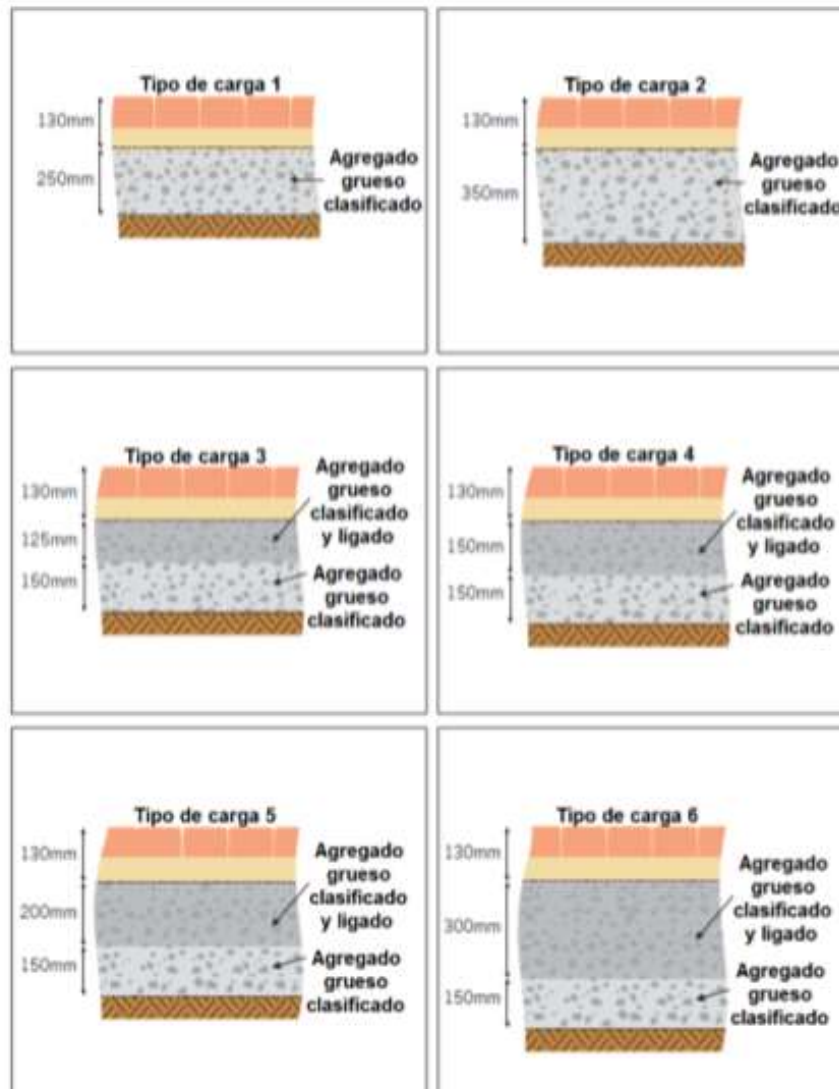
Espesores de la capa de almacenamiento para el caso infiltración total y parcial. Fuente: (Adaptado de Interpave, 2008).
